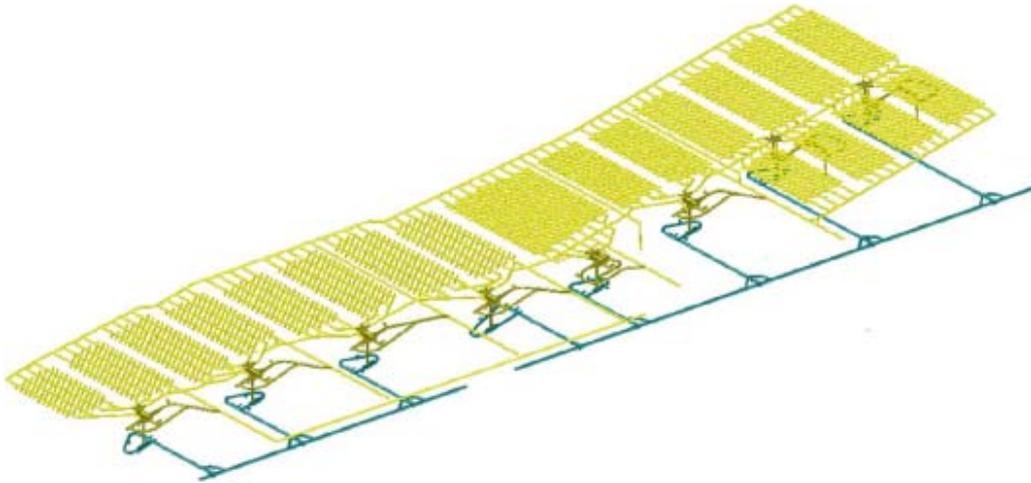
Vista Isométrica Nivel 1 – 1.841 con Layout Alternativa Propuesta
